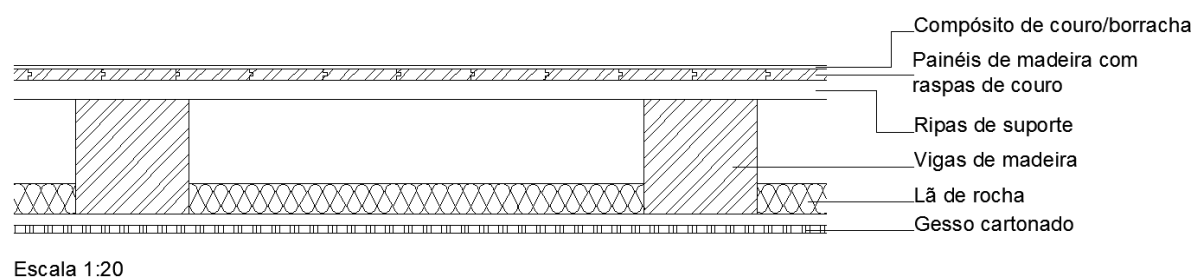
Detalhe construtivo de pavimento com painéis de fibras de madeira como base de suporte ao revestimento superficial
